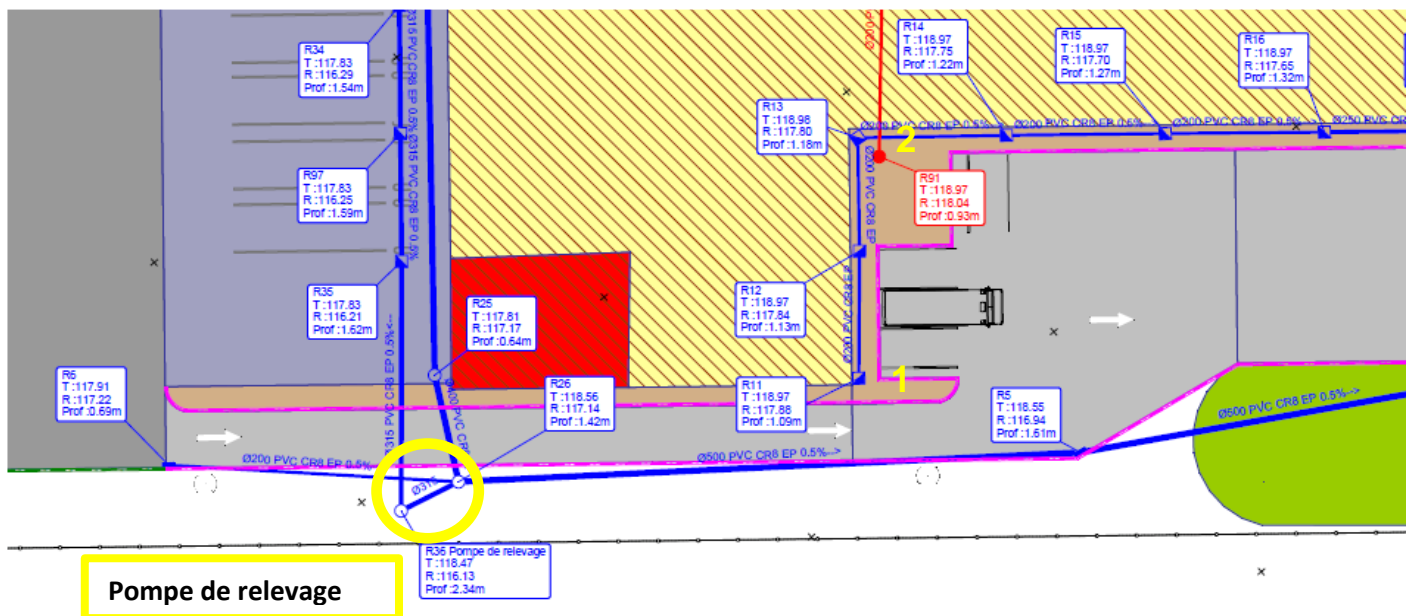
zoom du plan d'assainissement plate-forme Chronopost, source : document Colas Tours
